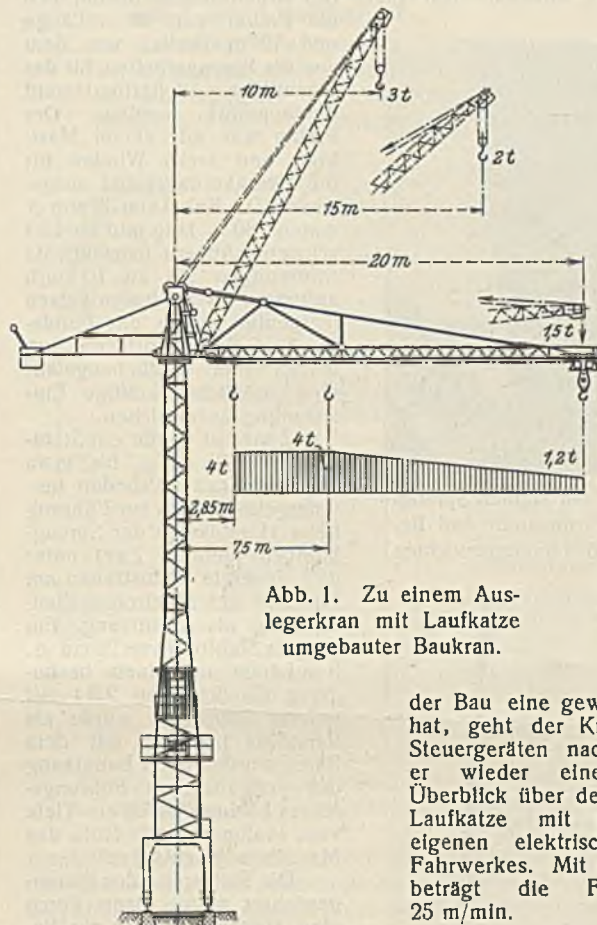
Zu einem Auslegerkran mit Laufkatze umgebauter Baukran.
